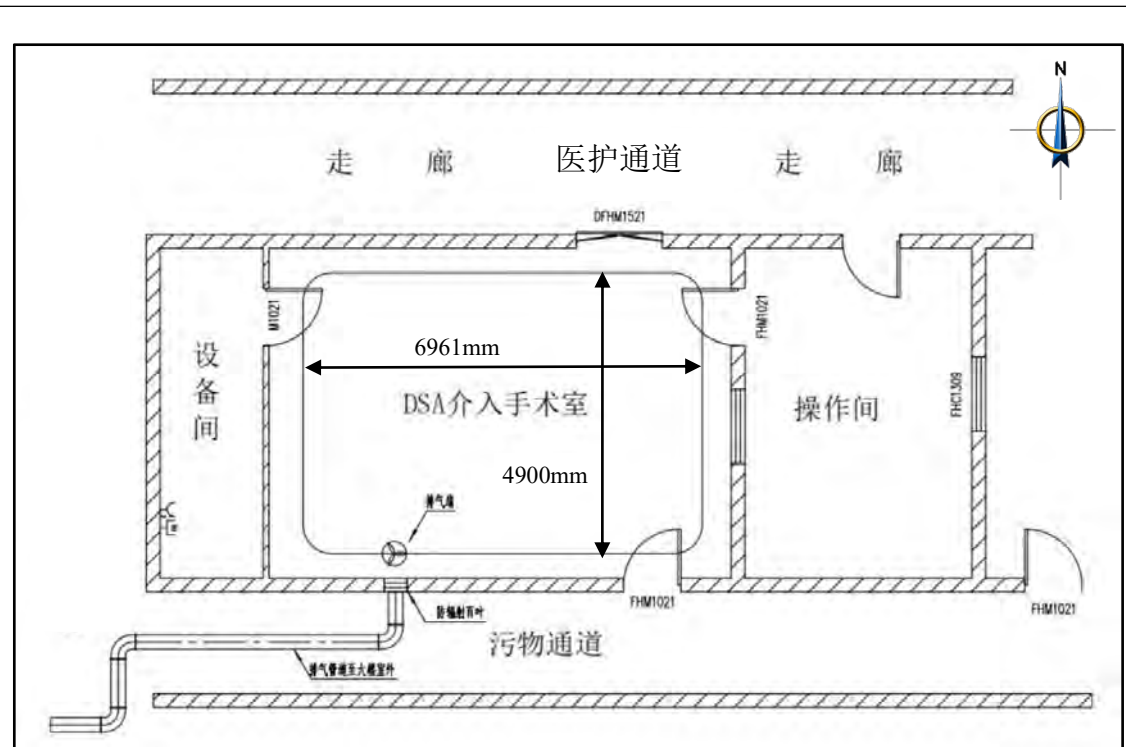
拟建 DSA 机房及其辅助用房完成后平面布置图
